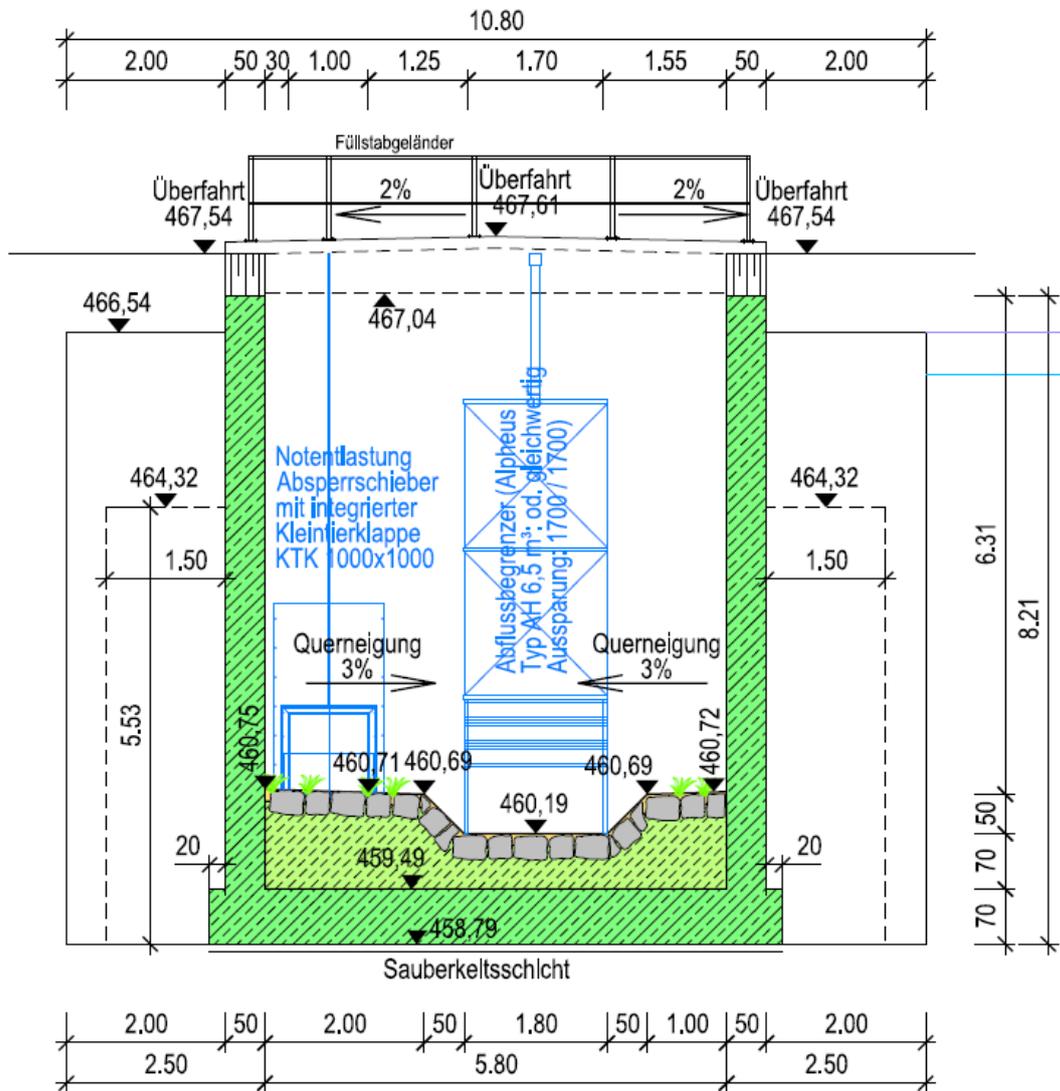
Planausschnitt (113474-24-HW) Querschnitt Durchlassbauwerk – Profilabmessungen
